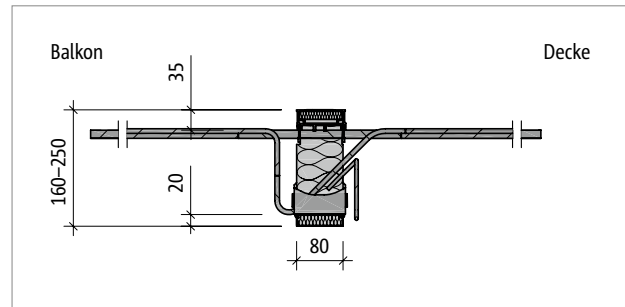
Schöck Isokorb® T Typ K-ID-M4: Produktschnitt
